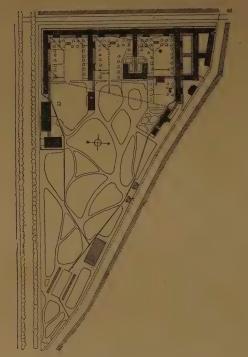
Lycée Lakanal, à Sceaux. Plan général.
